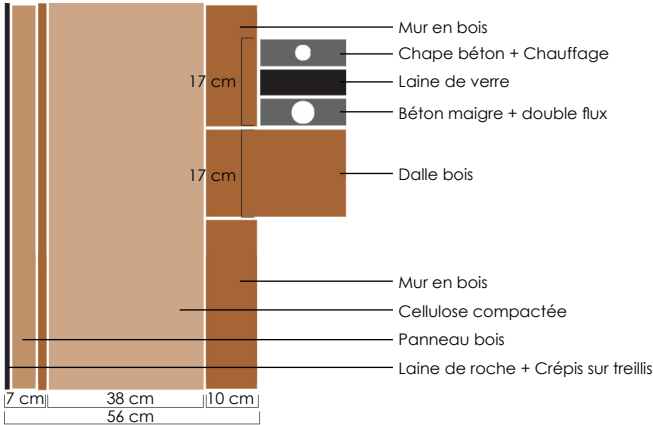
b Schéma du détail entre le mur de façade et la dalle. Source: Coopérative équilibre.
